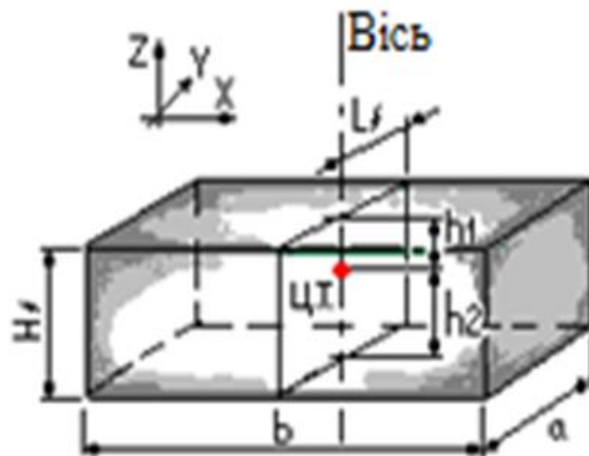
Розрахункова схема фундаменту на дію динамічних навантажень
